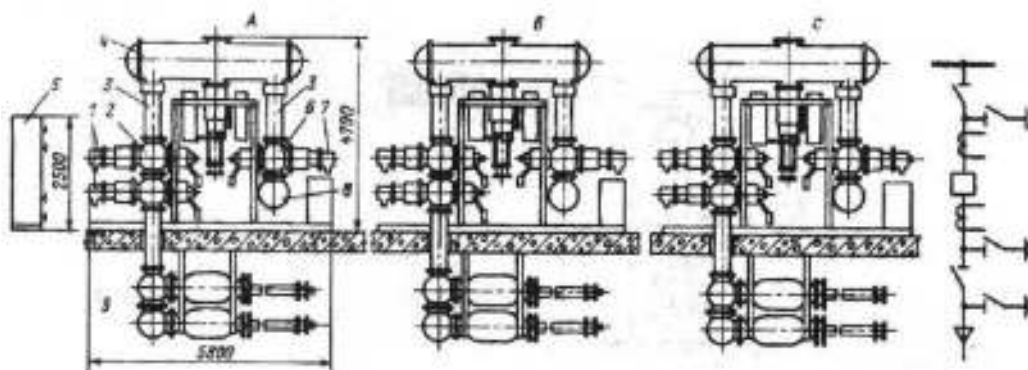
Комплектное РУ 220 кВ с элегазовой изоляцией. Ячейка линейная ЯЭ-220Л-11У4: 1 – блоки заземлителей линейного разъединителя; 2 – блок линейного разъединителя; 3 – блок трансформаторов тока; 4 – выключатель; 5 – распределительный шкаф; 6 – блок шинного разъединителя; 7 – блок заземлителя шинного разъединителя; 8 – блок сборной шины фазы А; 9 – блок
